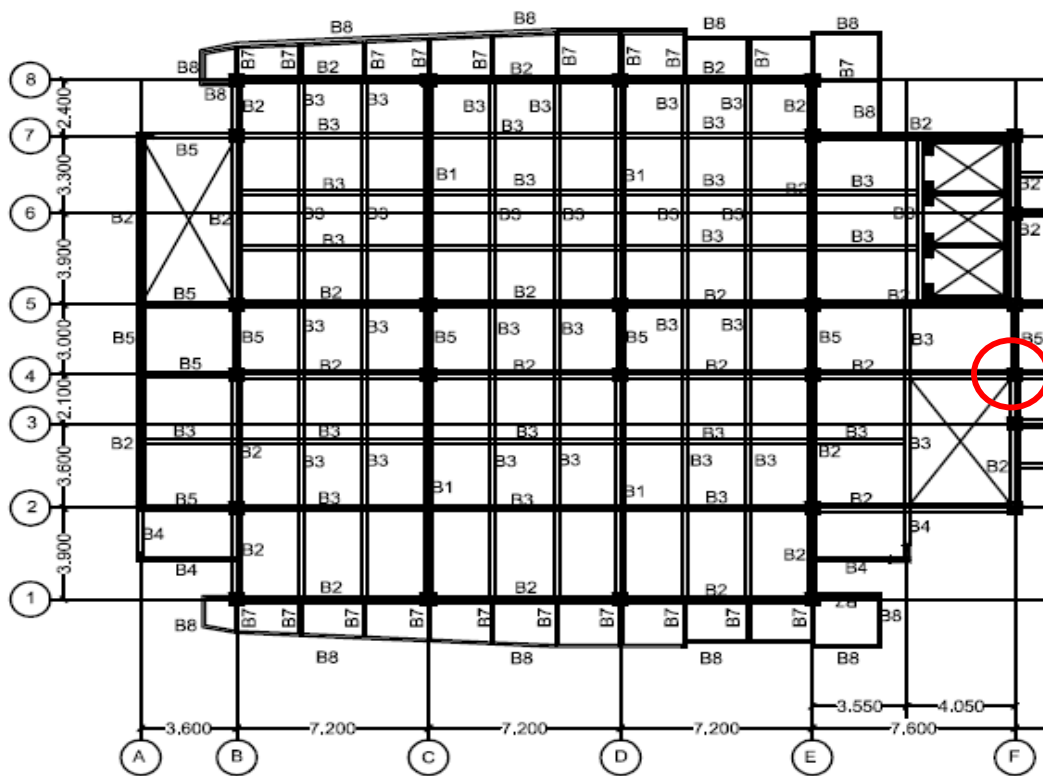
Denah Lantai Semi *Basement* Zona 1
